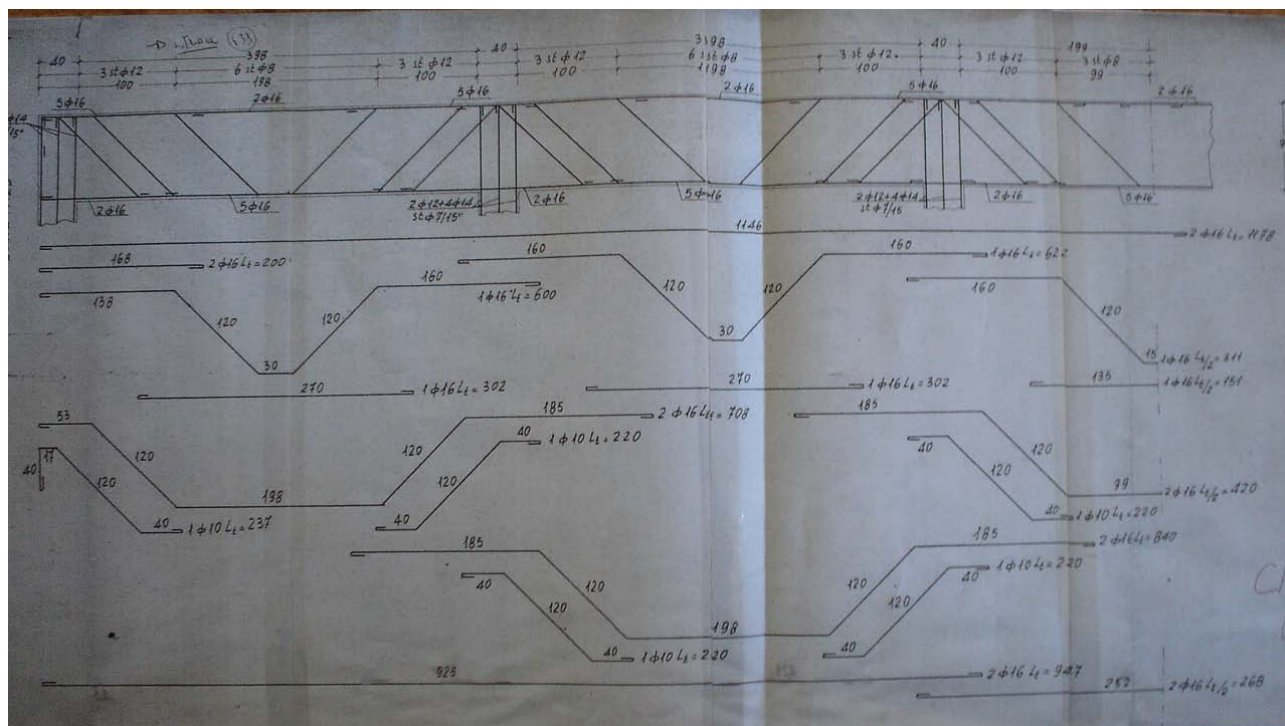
Estratto tavola strutturale trave porzione originaria – solaio di calpestio piano terra
